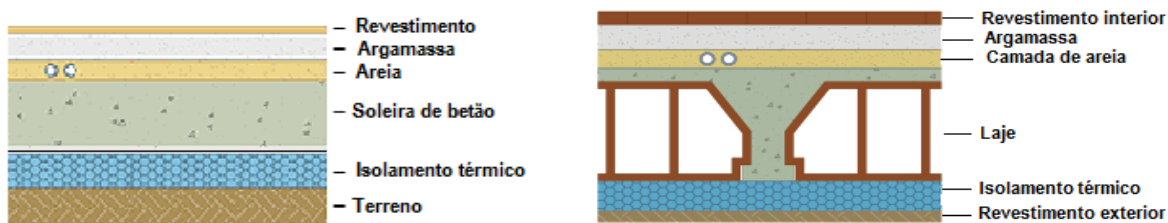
Constituição de pavimento térreo (esquerda) e pavimento de divisão com exterior ou espaços não aquecidos (direita). Fonte: adaptado de building.dow.com.
